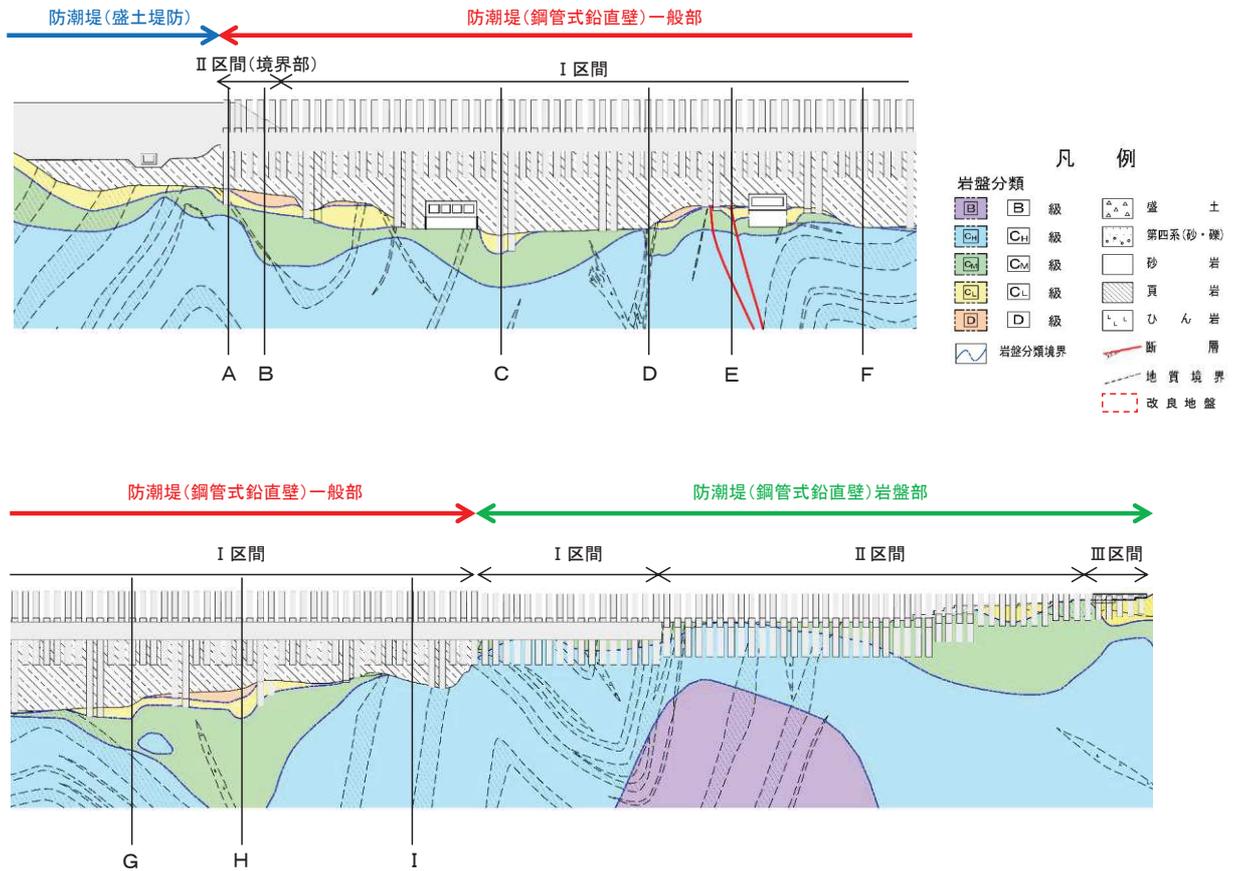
鋼管式鉛直壁（一般部）縦断面図
